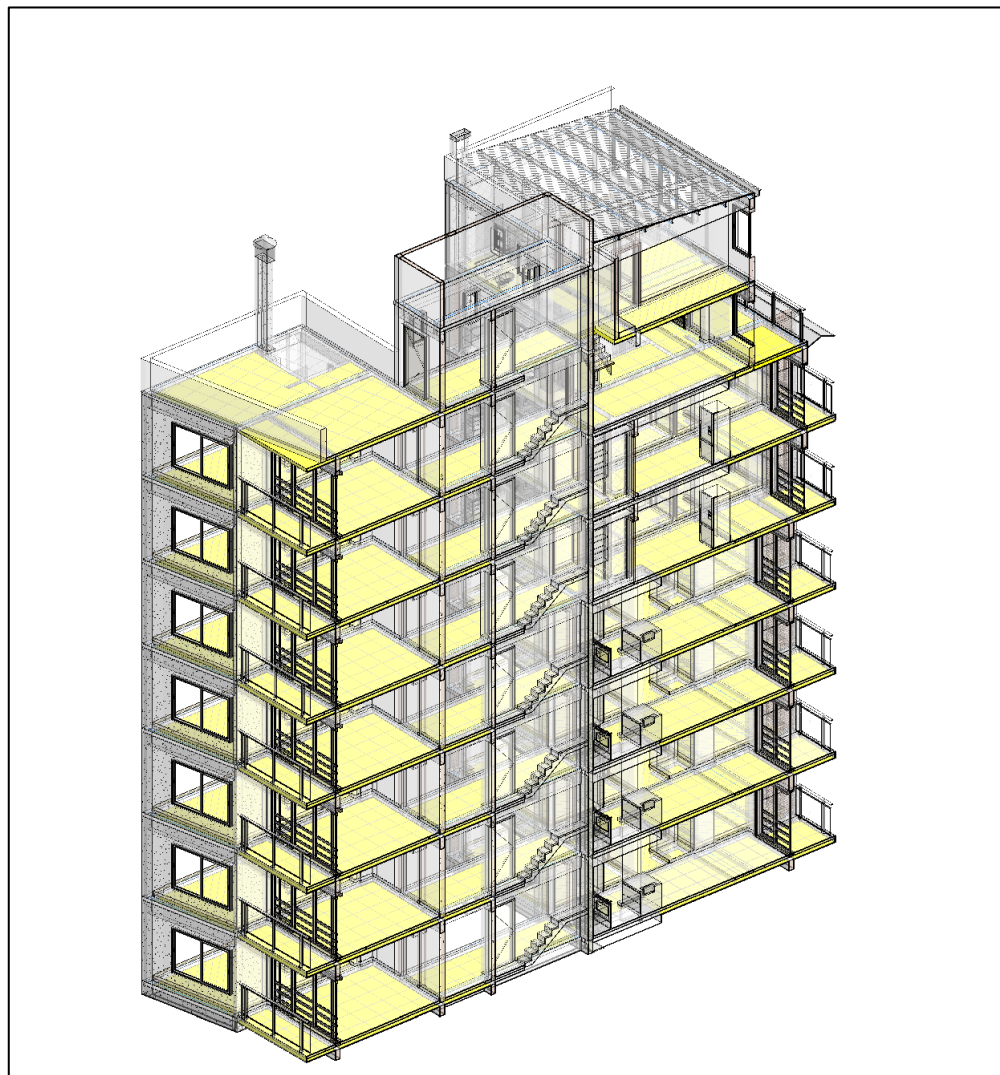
Ítem 7.1: Mortero a la cal aplicado bajo losa.
